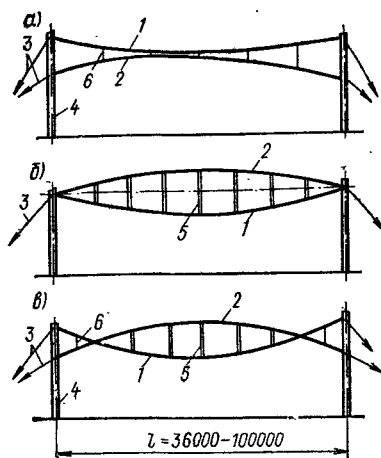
Схемы двухпоясных висячих покрытий на прямоугольном плане
